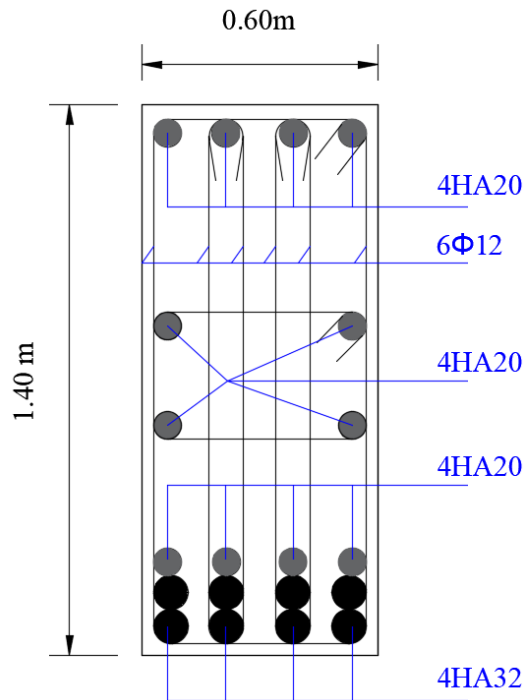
ferrailage de la poutre principale (60×140) en travée
